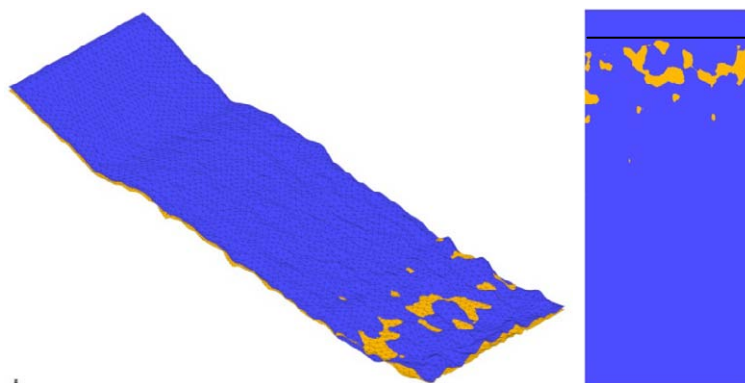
Vistas de la rotura en la presa protegida con escalón de caudal 34,6 l/s/m. Izquierda: perspectiva. Derecha: planta con el pie original resaltado con línea negra.
